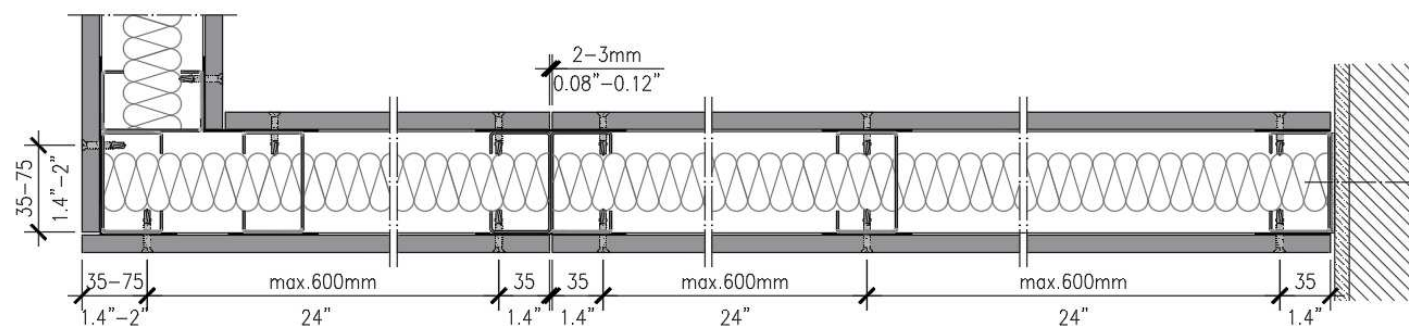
Secção horizontal da parede, estrutura de aço galvanizado
